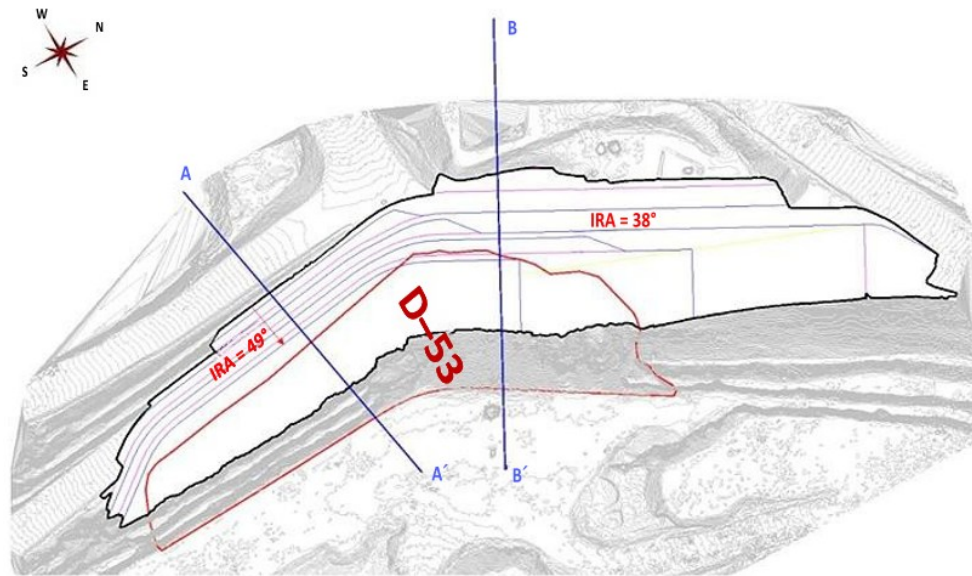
Vista en planta del diseño propuesto por Ingeniería Mina
